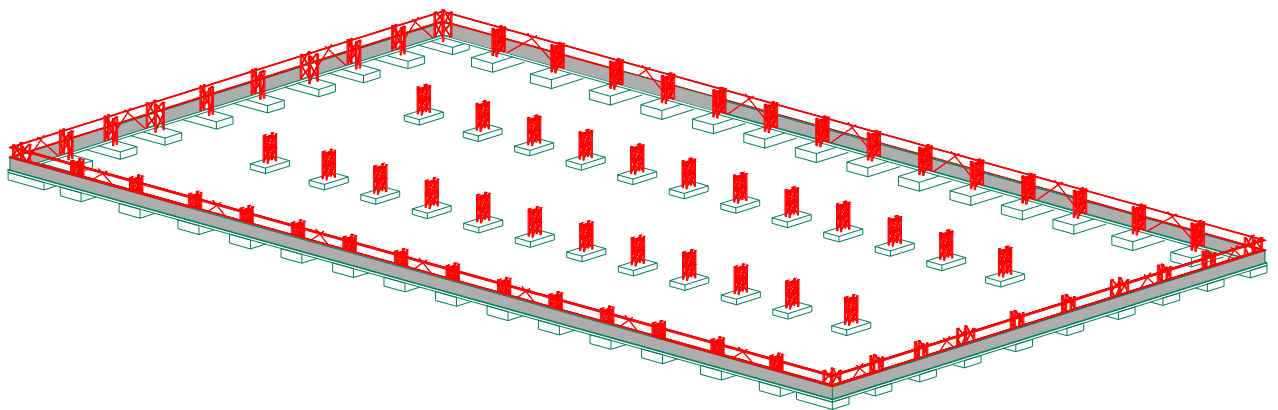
PLANTA DE CIMENTACIÓN CON ZAPATAS AISLADAS Y MURO PERIMETRAL
